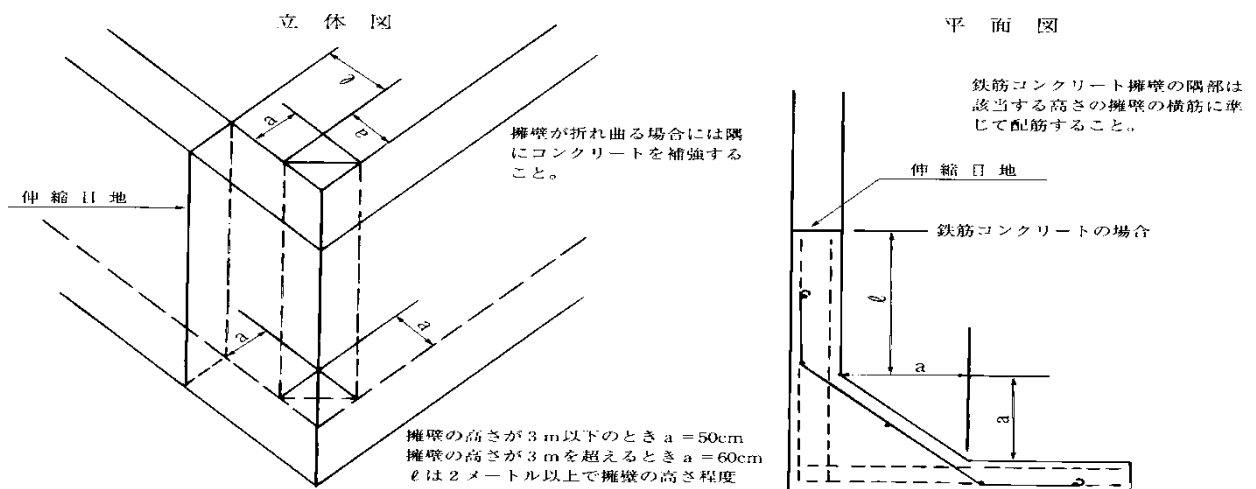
擁壁の隅角部の補強図（鉄筋コンクリート造等擁壁）
